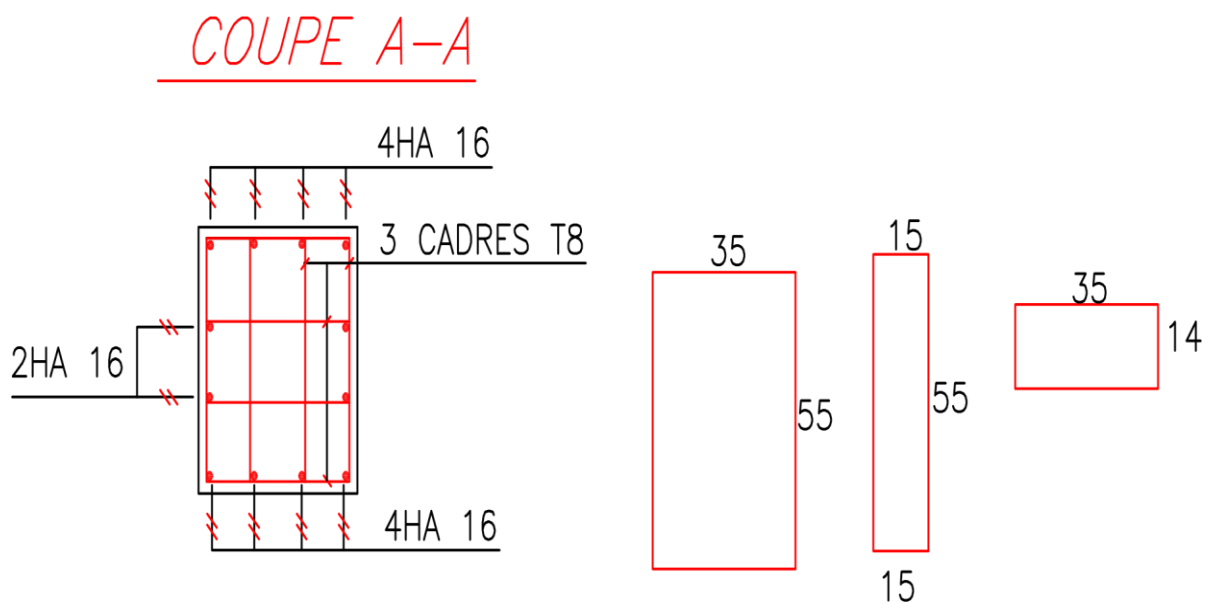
Coupe A-A de ferrailage des poteaux 60×40 cm²
